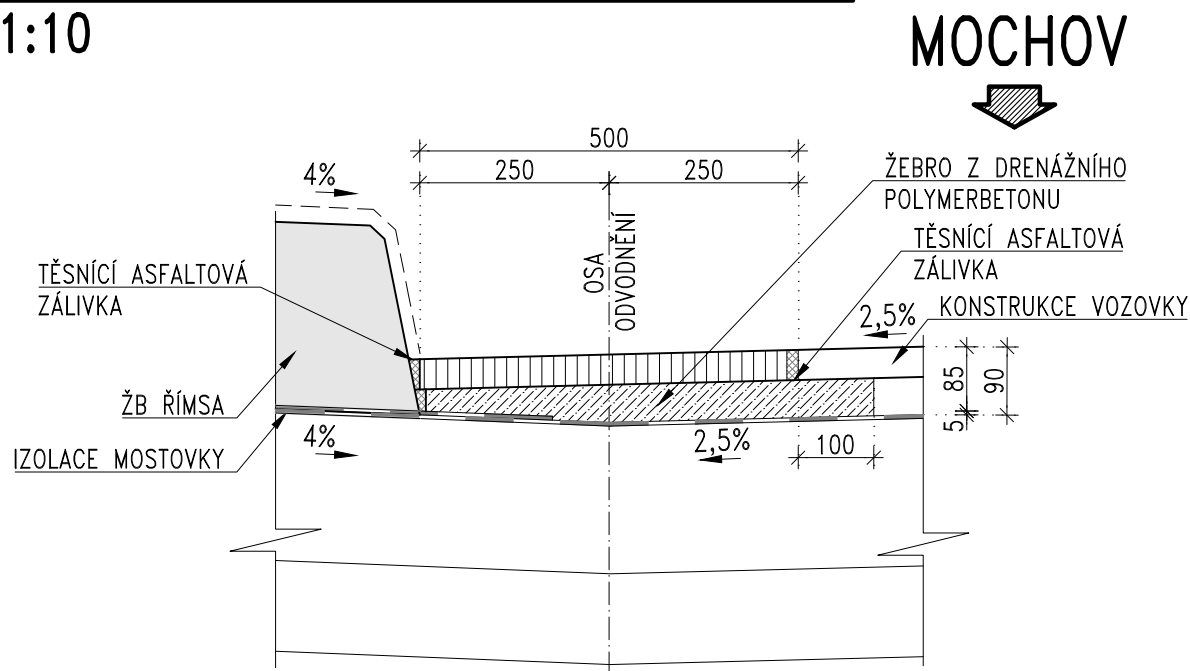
ODVODNĚNÍ IZOLACE DRENÁŽNÍM POLYMORBETONEM ŘEZY MIMO ODVODŇOVACÍ TRUBIČKY
